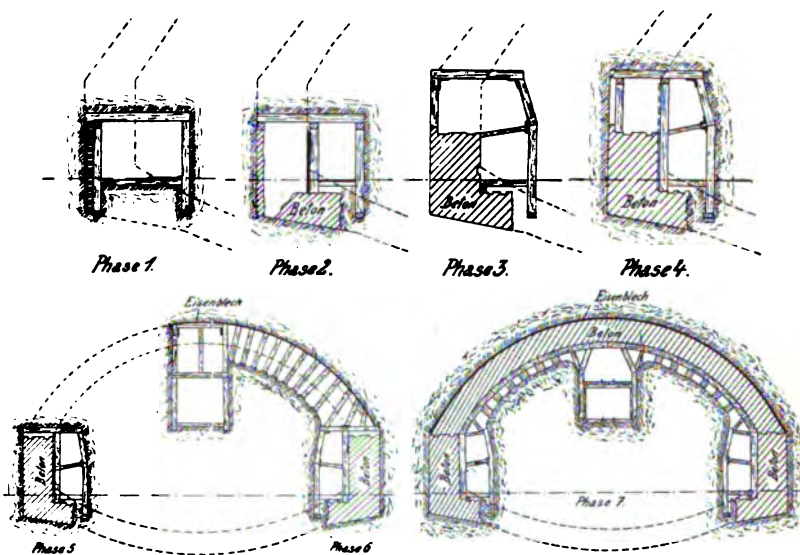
Bauphasen des Tunnels in der Atlantic Avenue-Station.
